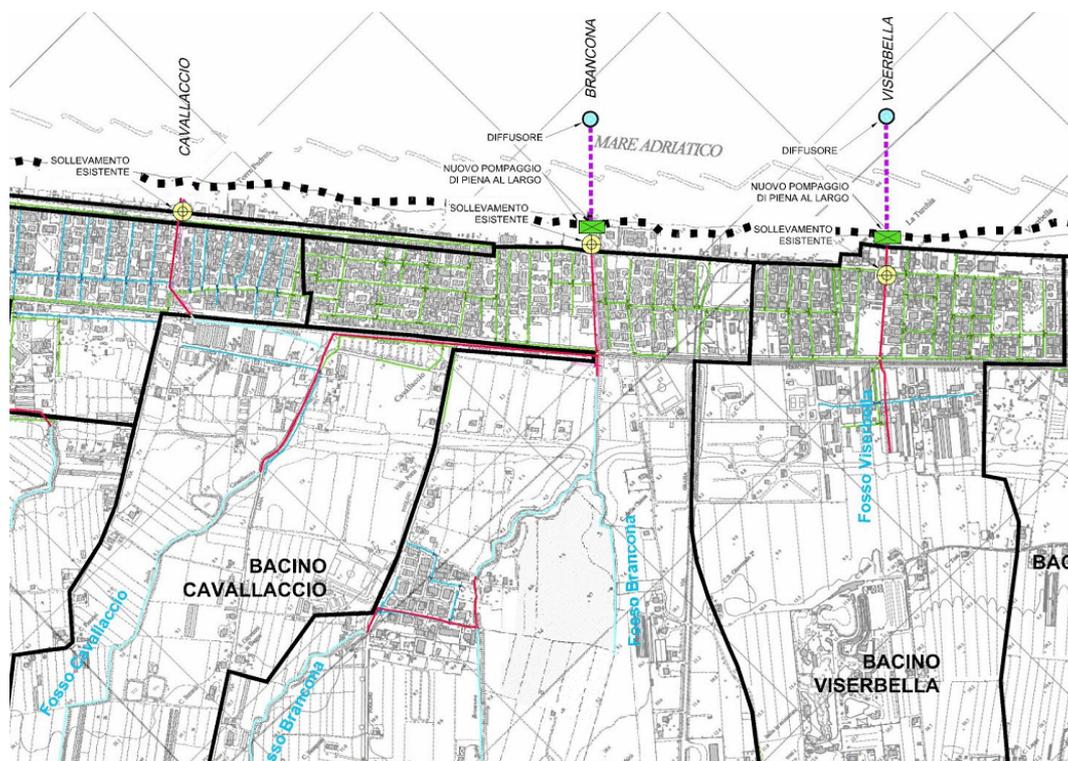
Individuazione planimetrica dell'intervento sulla fossa Brancona.
